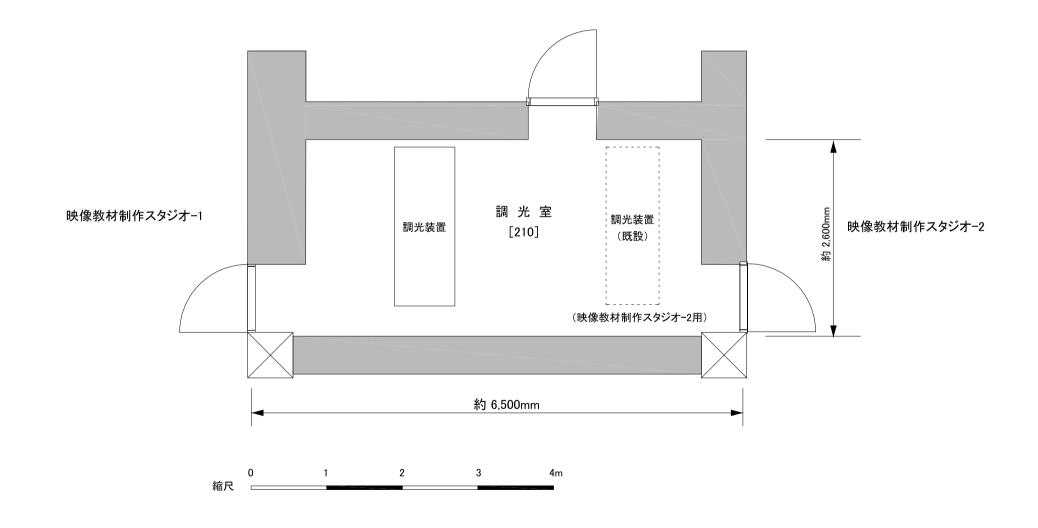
映像教材制作スタジオ-1 調光室機材配置図
